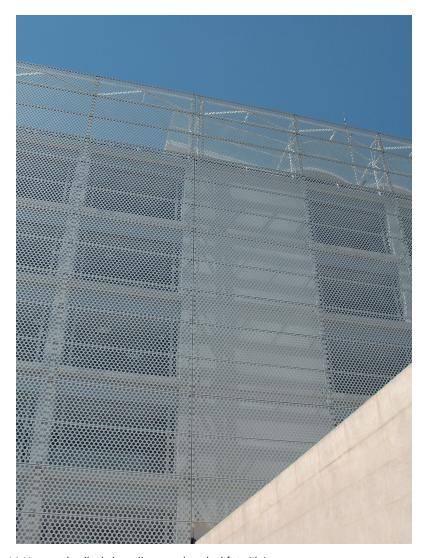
Vista en detalle de la malla que cubre al edificio (Ib.).
